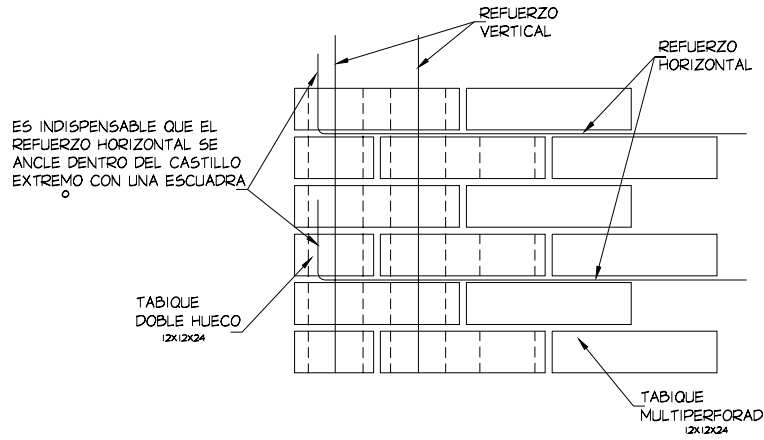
Detalle del anclaje del refuerzo horizontal
